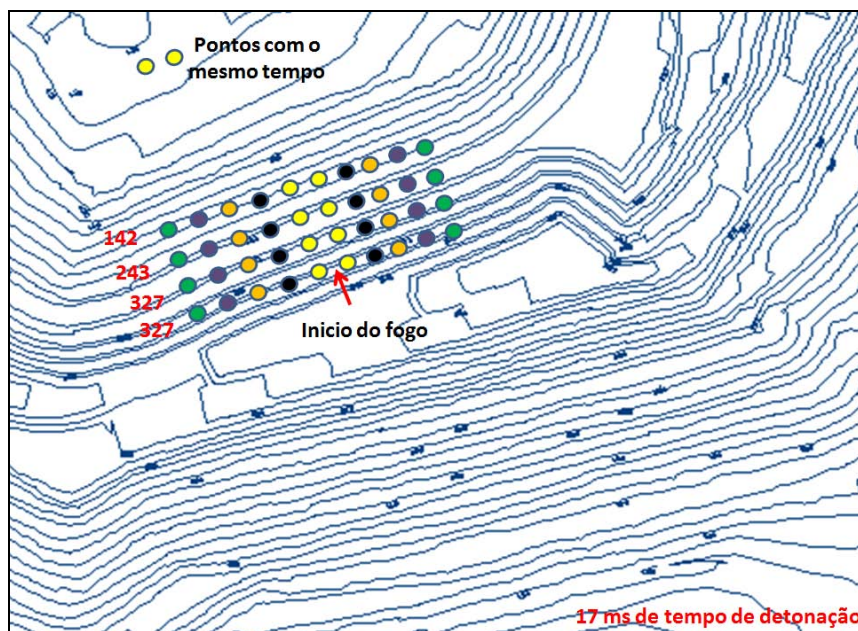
Plano de tempos de detonação em mili segundos por fileira de perfuração.
